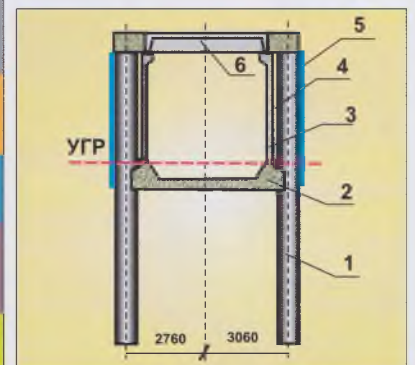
Поперечный разрез перегонного тоннеля: 1 - буронабивная свая, 2 - монолитный лоток, объединенный с буронабивными сваями, 3 - стеновой блок, 4 - оклеечная гидроизоляция, 5 - деревянная затяжка, 6 - плита покрытия
